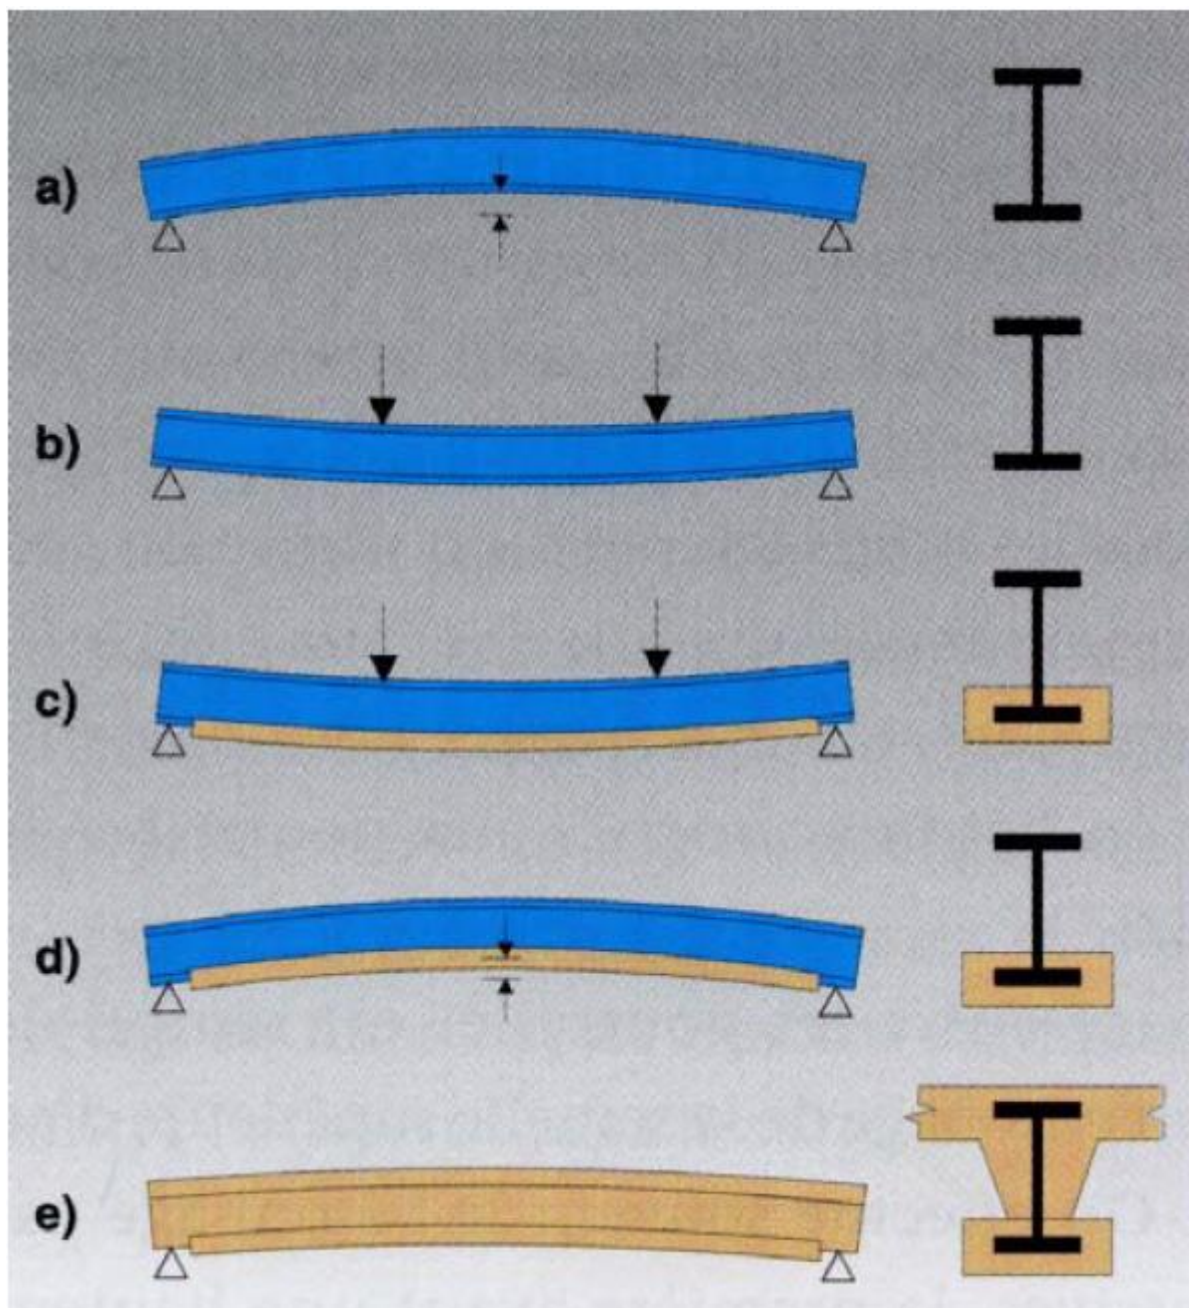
Processo de fabricação Viga “Preflex”: (a) viga de aço na posição inicial; (b) aplicação das forças verticais; (c) concretagem da mesa inferior; (d) retirada das forças verticais; (e) concretagem do perfil e da laje. Fonte: Mannini,2002.
